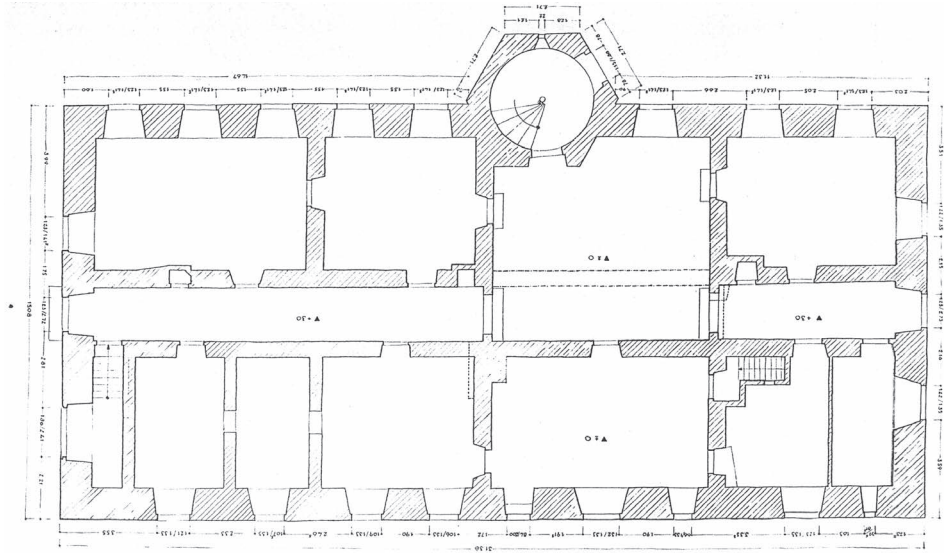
Propstei des Klosters St. Blasien in Krozingen, Grundriss des EG
